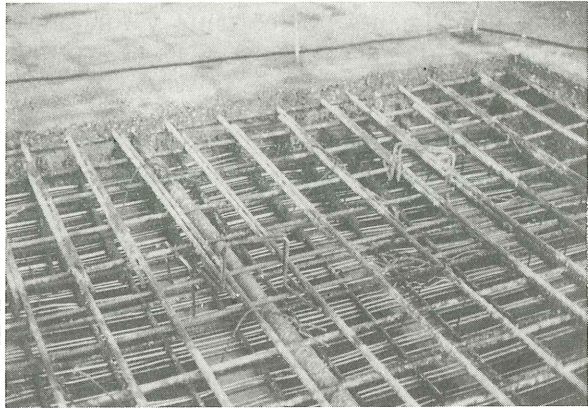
Detalle de junta de hormigonado y del encofrado para el hormigón de 2ª fase.
